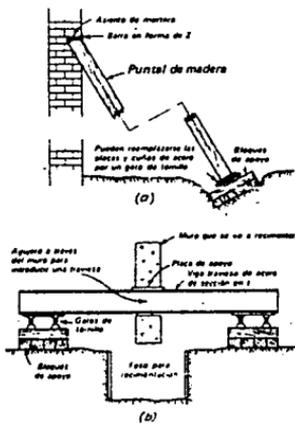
METODOS DE APUNTALAMIENTO a) CON RAMBLAS EN LA PARED b) VIGA ATRAVESADA
